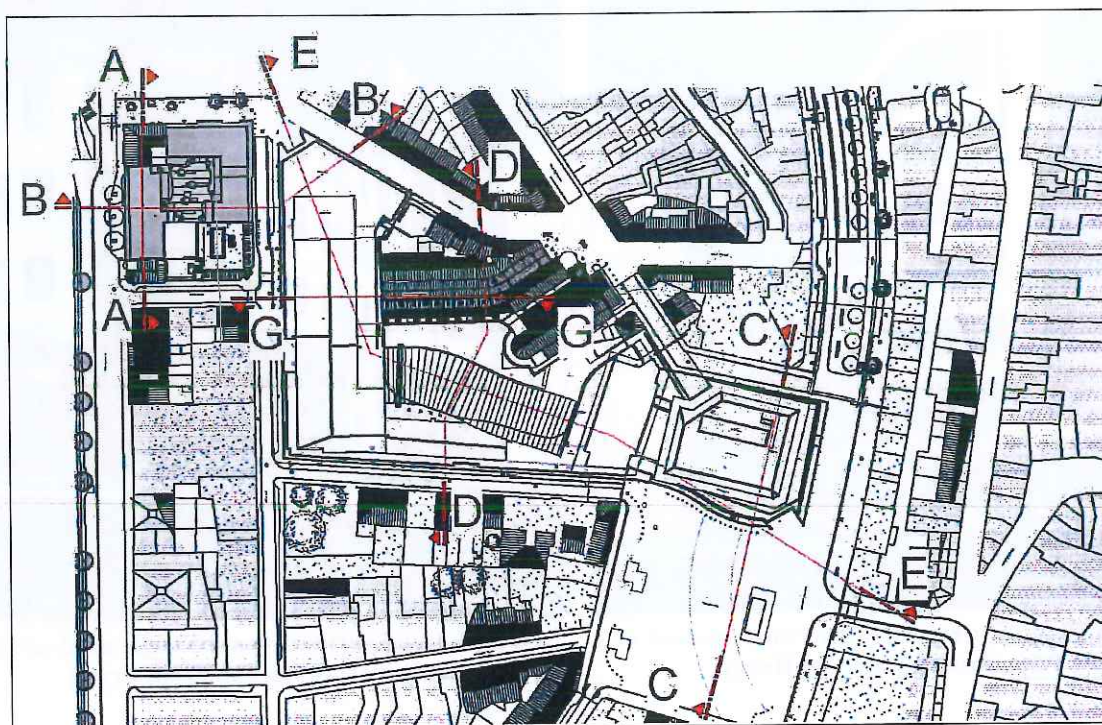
Indication des traits de coupes sur le plan d'implantation général (source : DDS & Partners)
